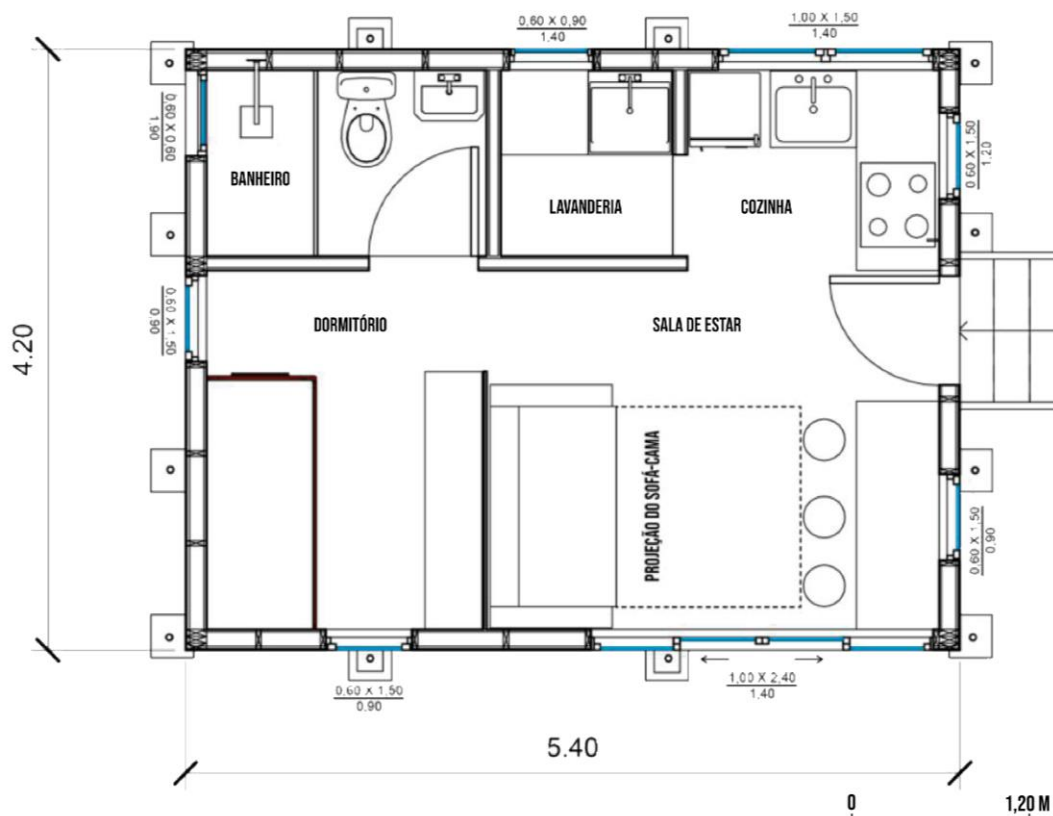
Planta modular – Fonte: elaborado pelos autores.
